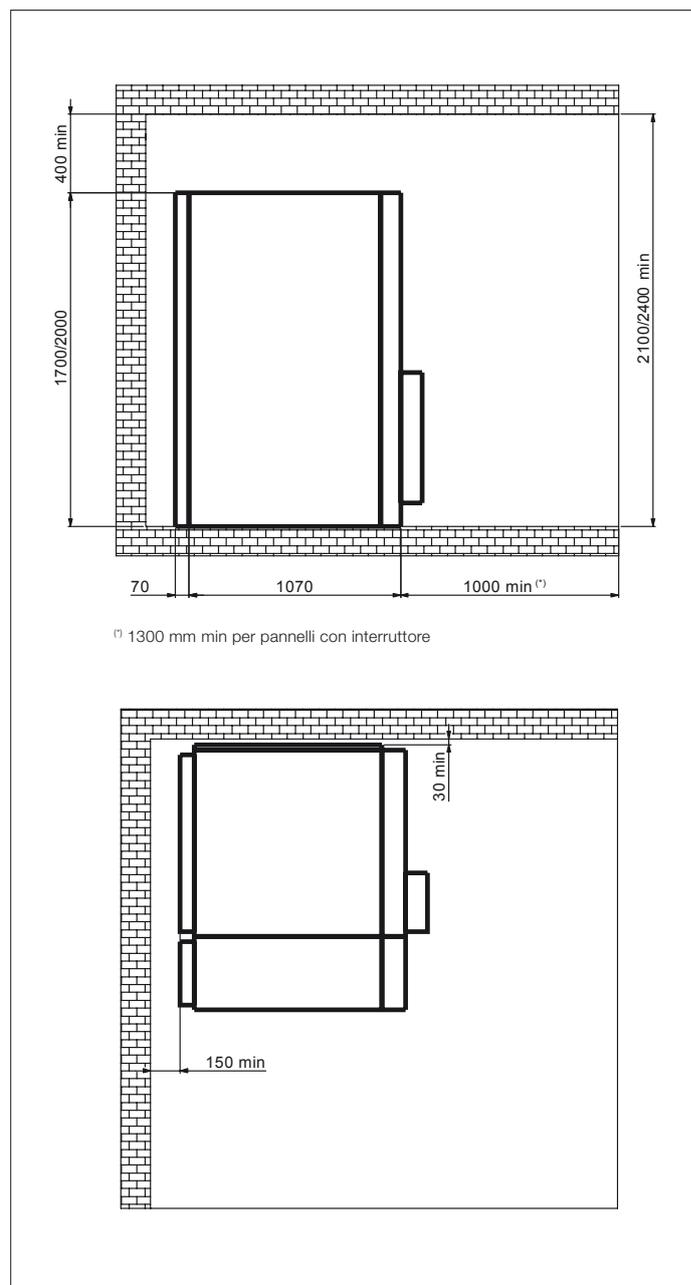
Distanze minime rispetto alle pareti del locale di installazione, soluzione IAC A-FL 12,5 kA 1s con filtri montati su ogni singola unità
